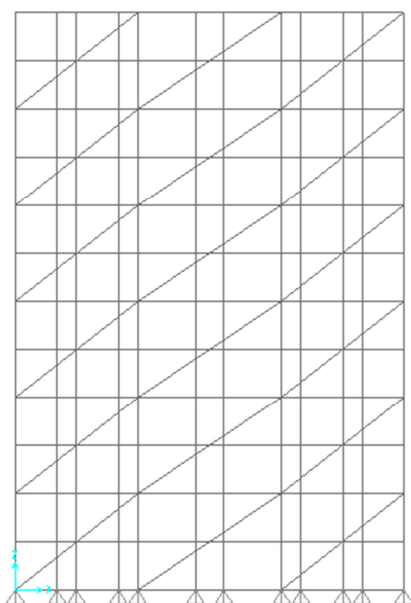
Configuração dos Planos de Contraventamento Vertical Com Elementos de Contraventamento Grandes
